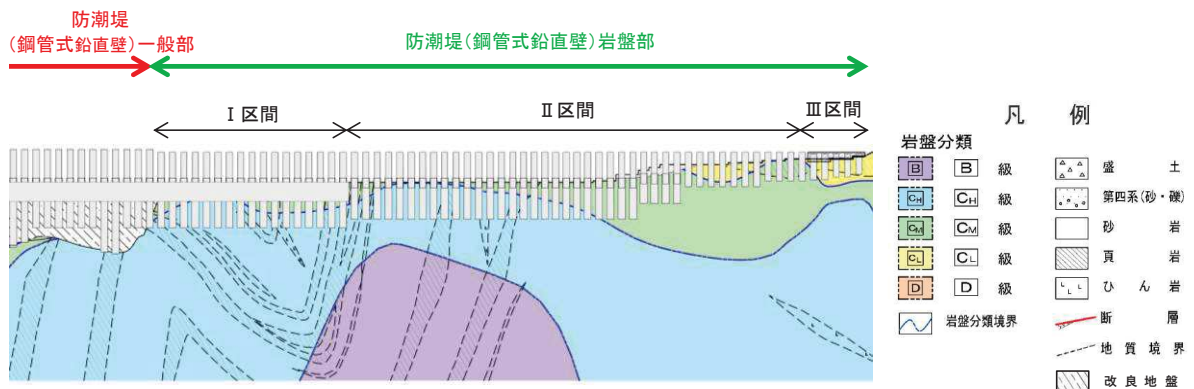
鋼管式鉛直壁（岩盤部）の縦断図
